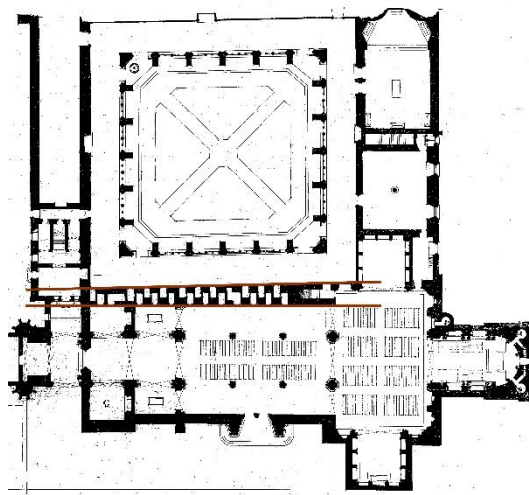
Direções distintas do muro norte da igreja e muro sul do claustro. Fonte: SIPA DES.00050407 editado pela autora.
